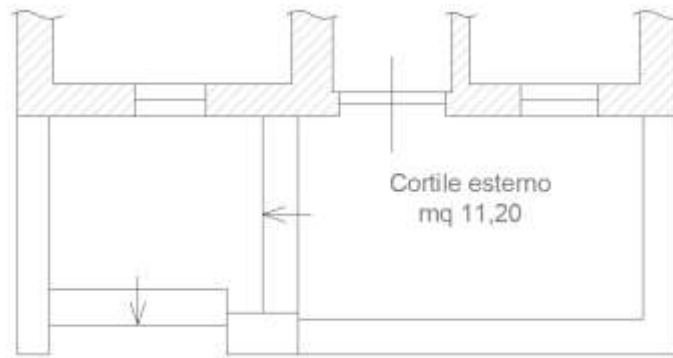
planimetria del cortile ricavato nel retro dell'appartamento.
